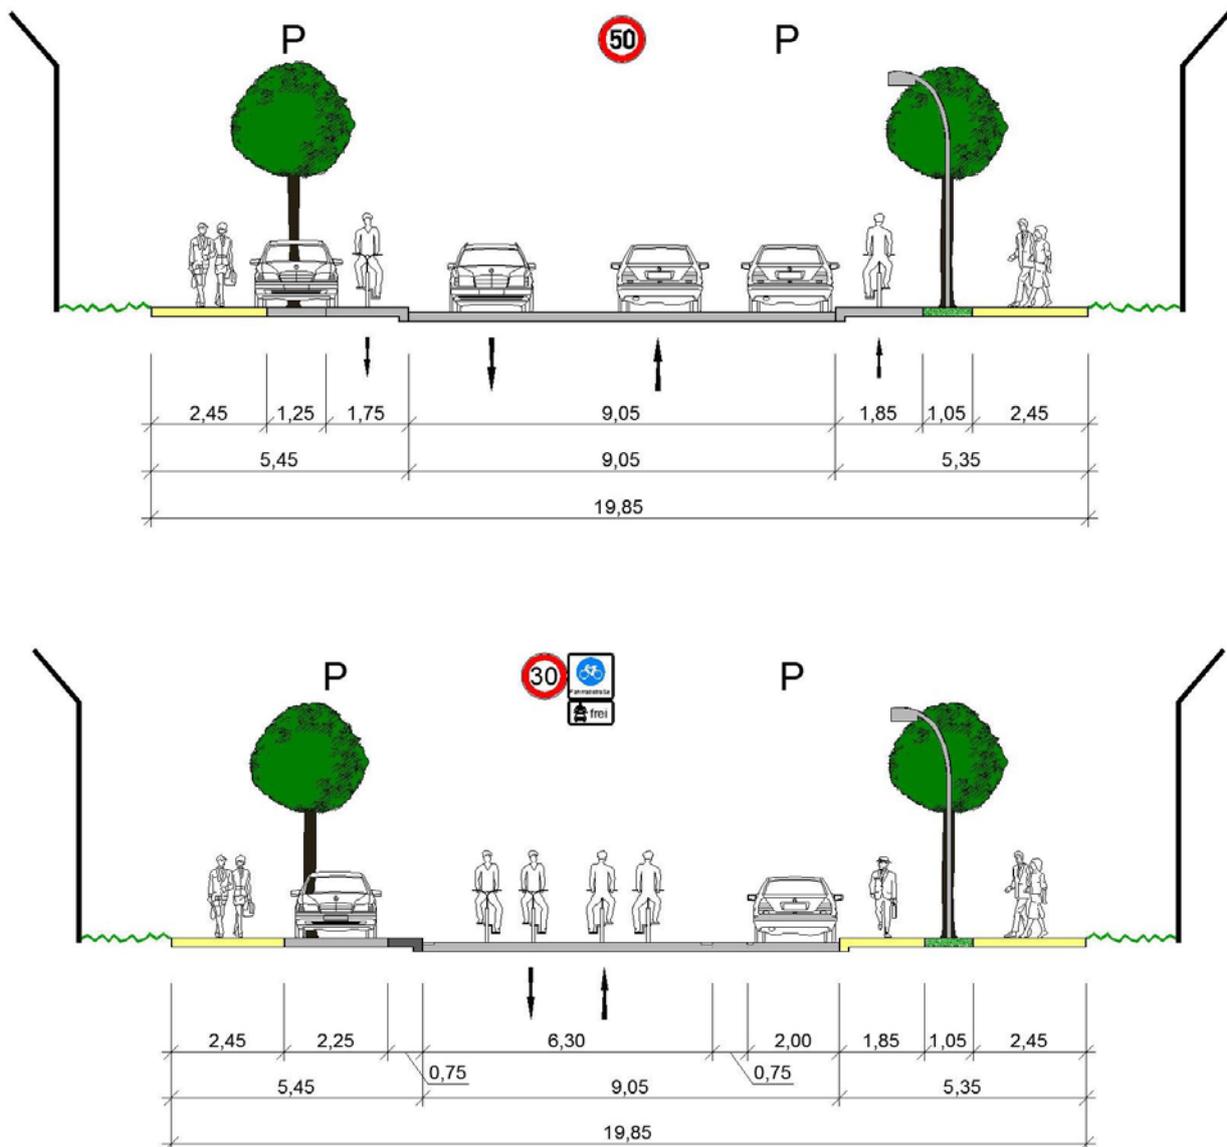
Friedrich-Ebert-Straße / Bahnhofstraße (Hardenbergstraße bis Polderstraße) – Bestand (oben) und Planung (unten)
